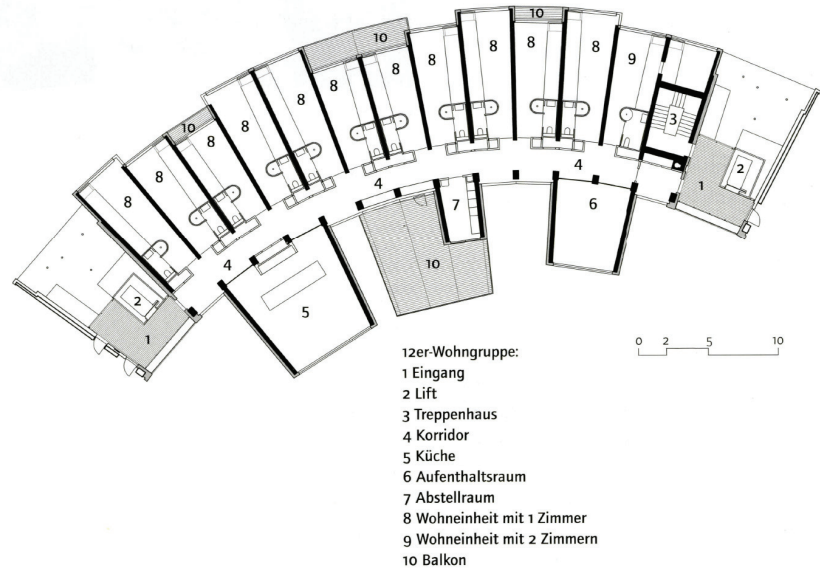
Grundriss eines WG-Segments mit 12 Zimmern
